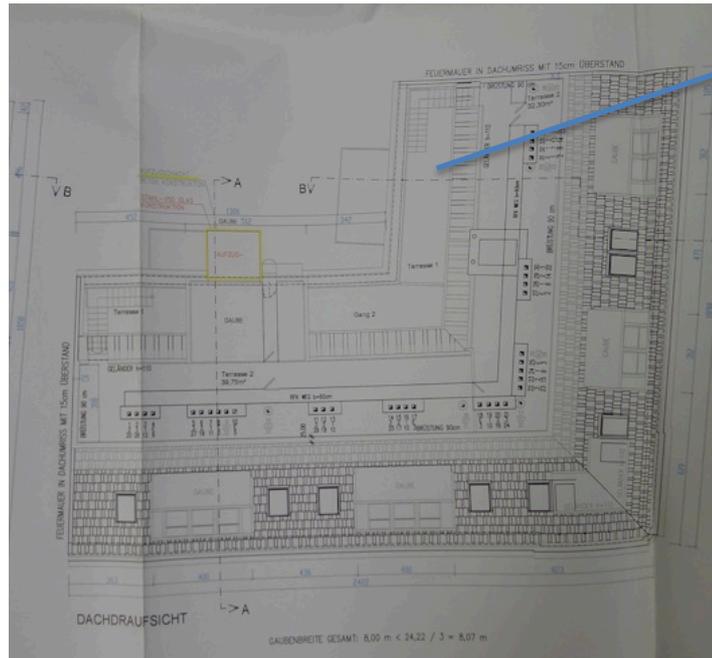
Grundriss Top 33 2. Dachgeschoss
